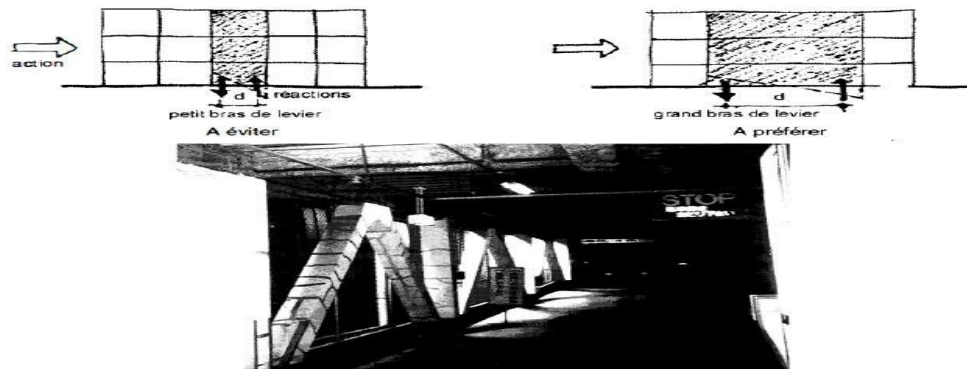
Largeur des éléments verticaux de contreventement [13].
